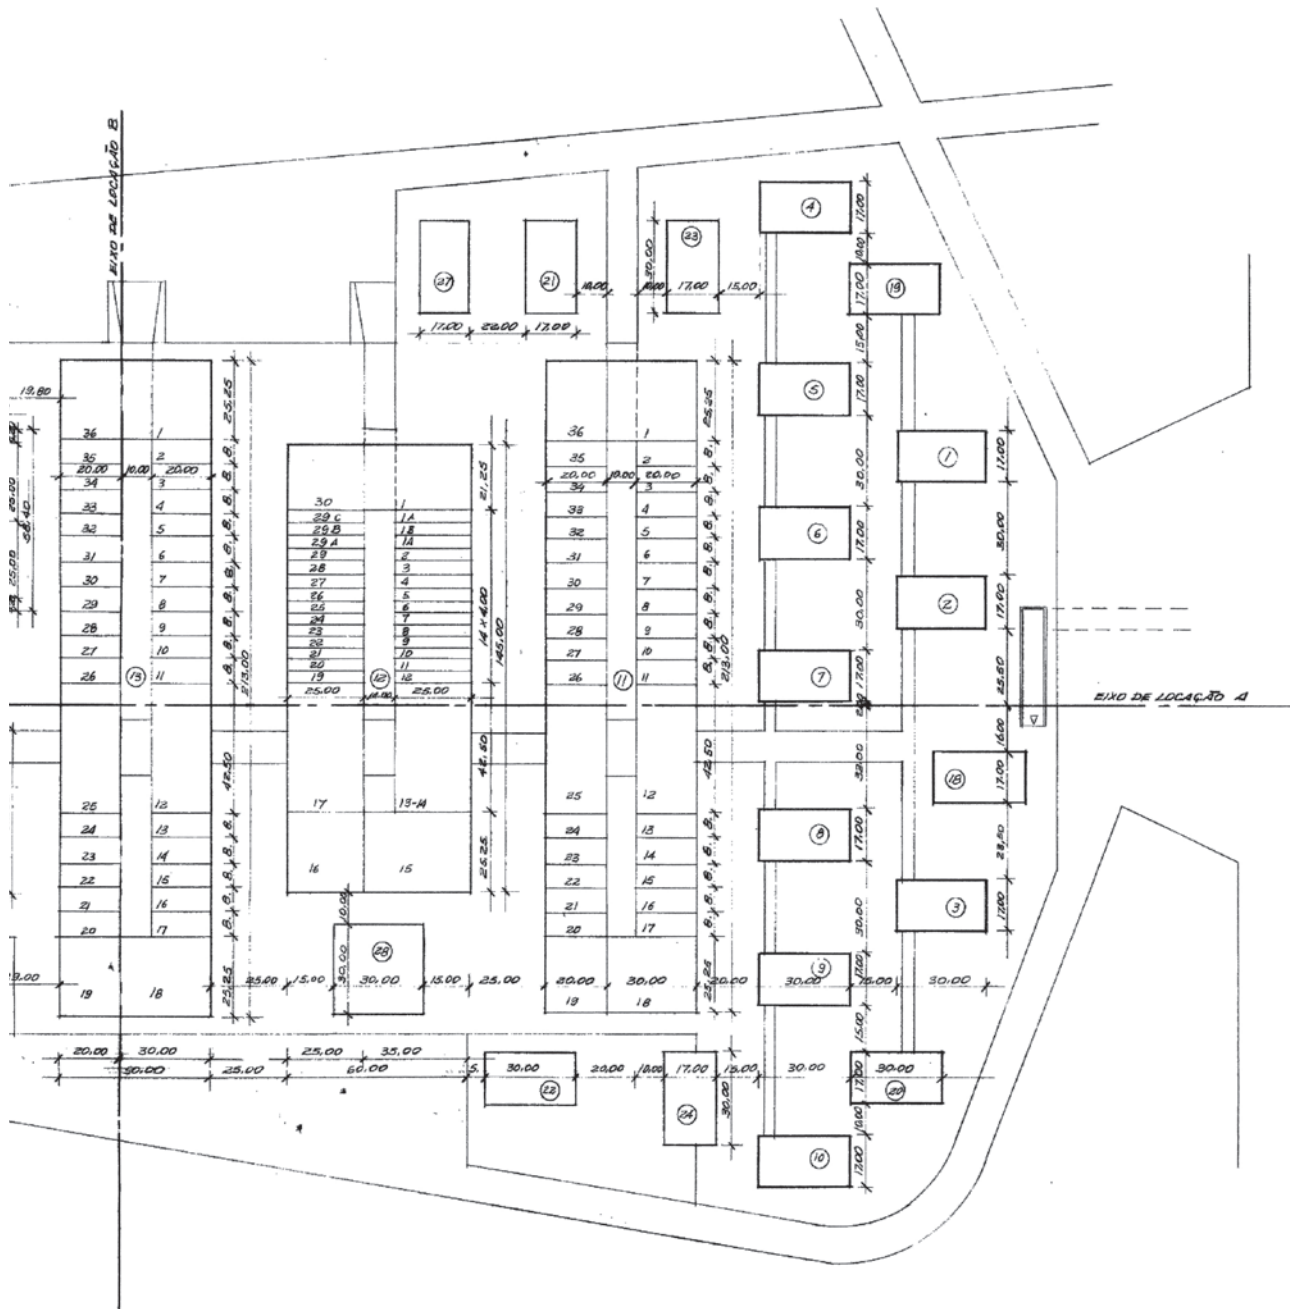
Projeto urbanístico do SCS - Planta de Pavimento-tipo (SCS-2 3-10)
